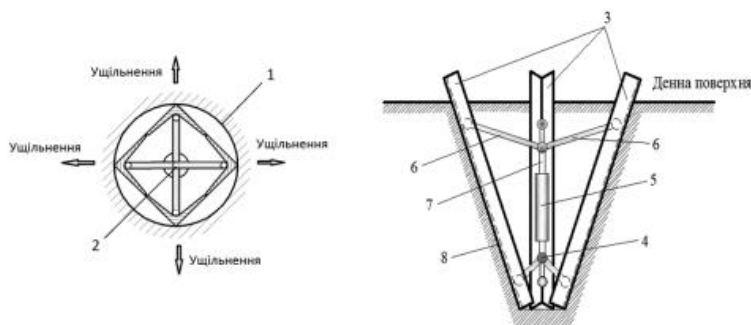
Процес влаштування ущільнення стінок котловану під фундамент
